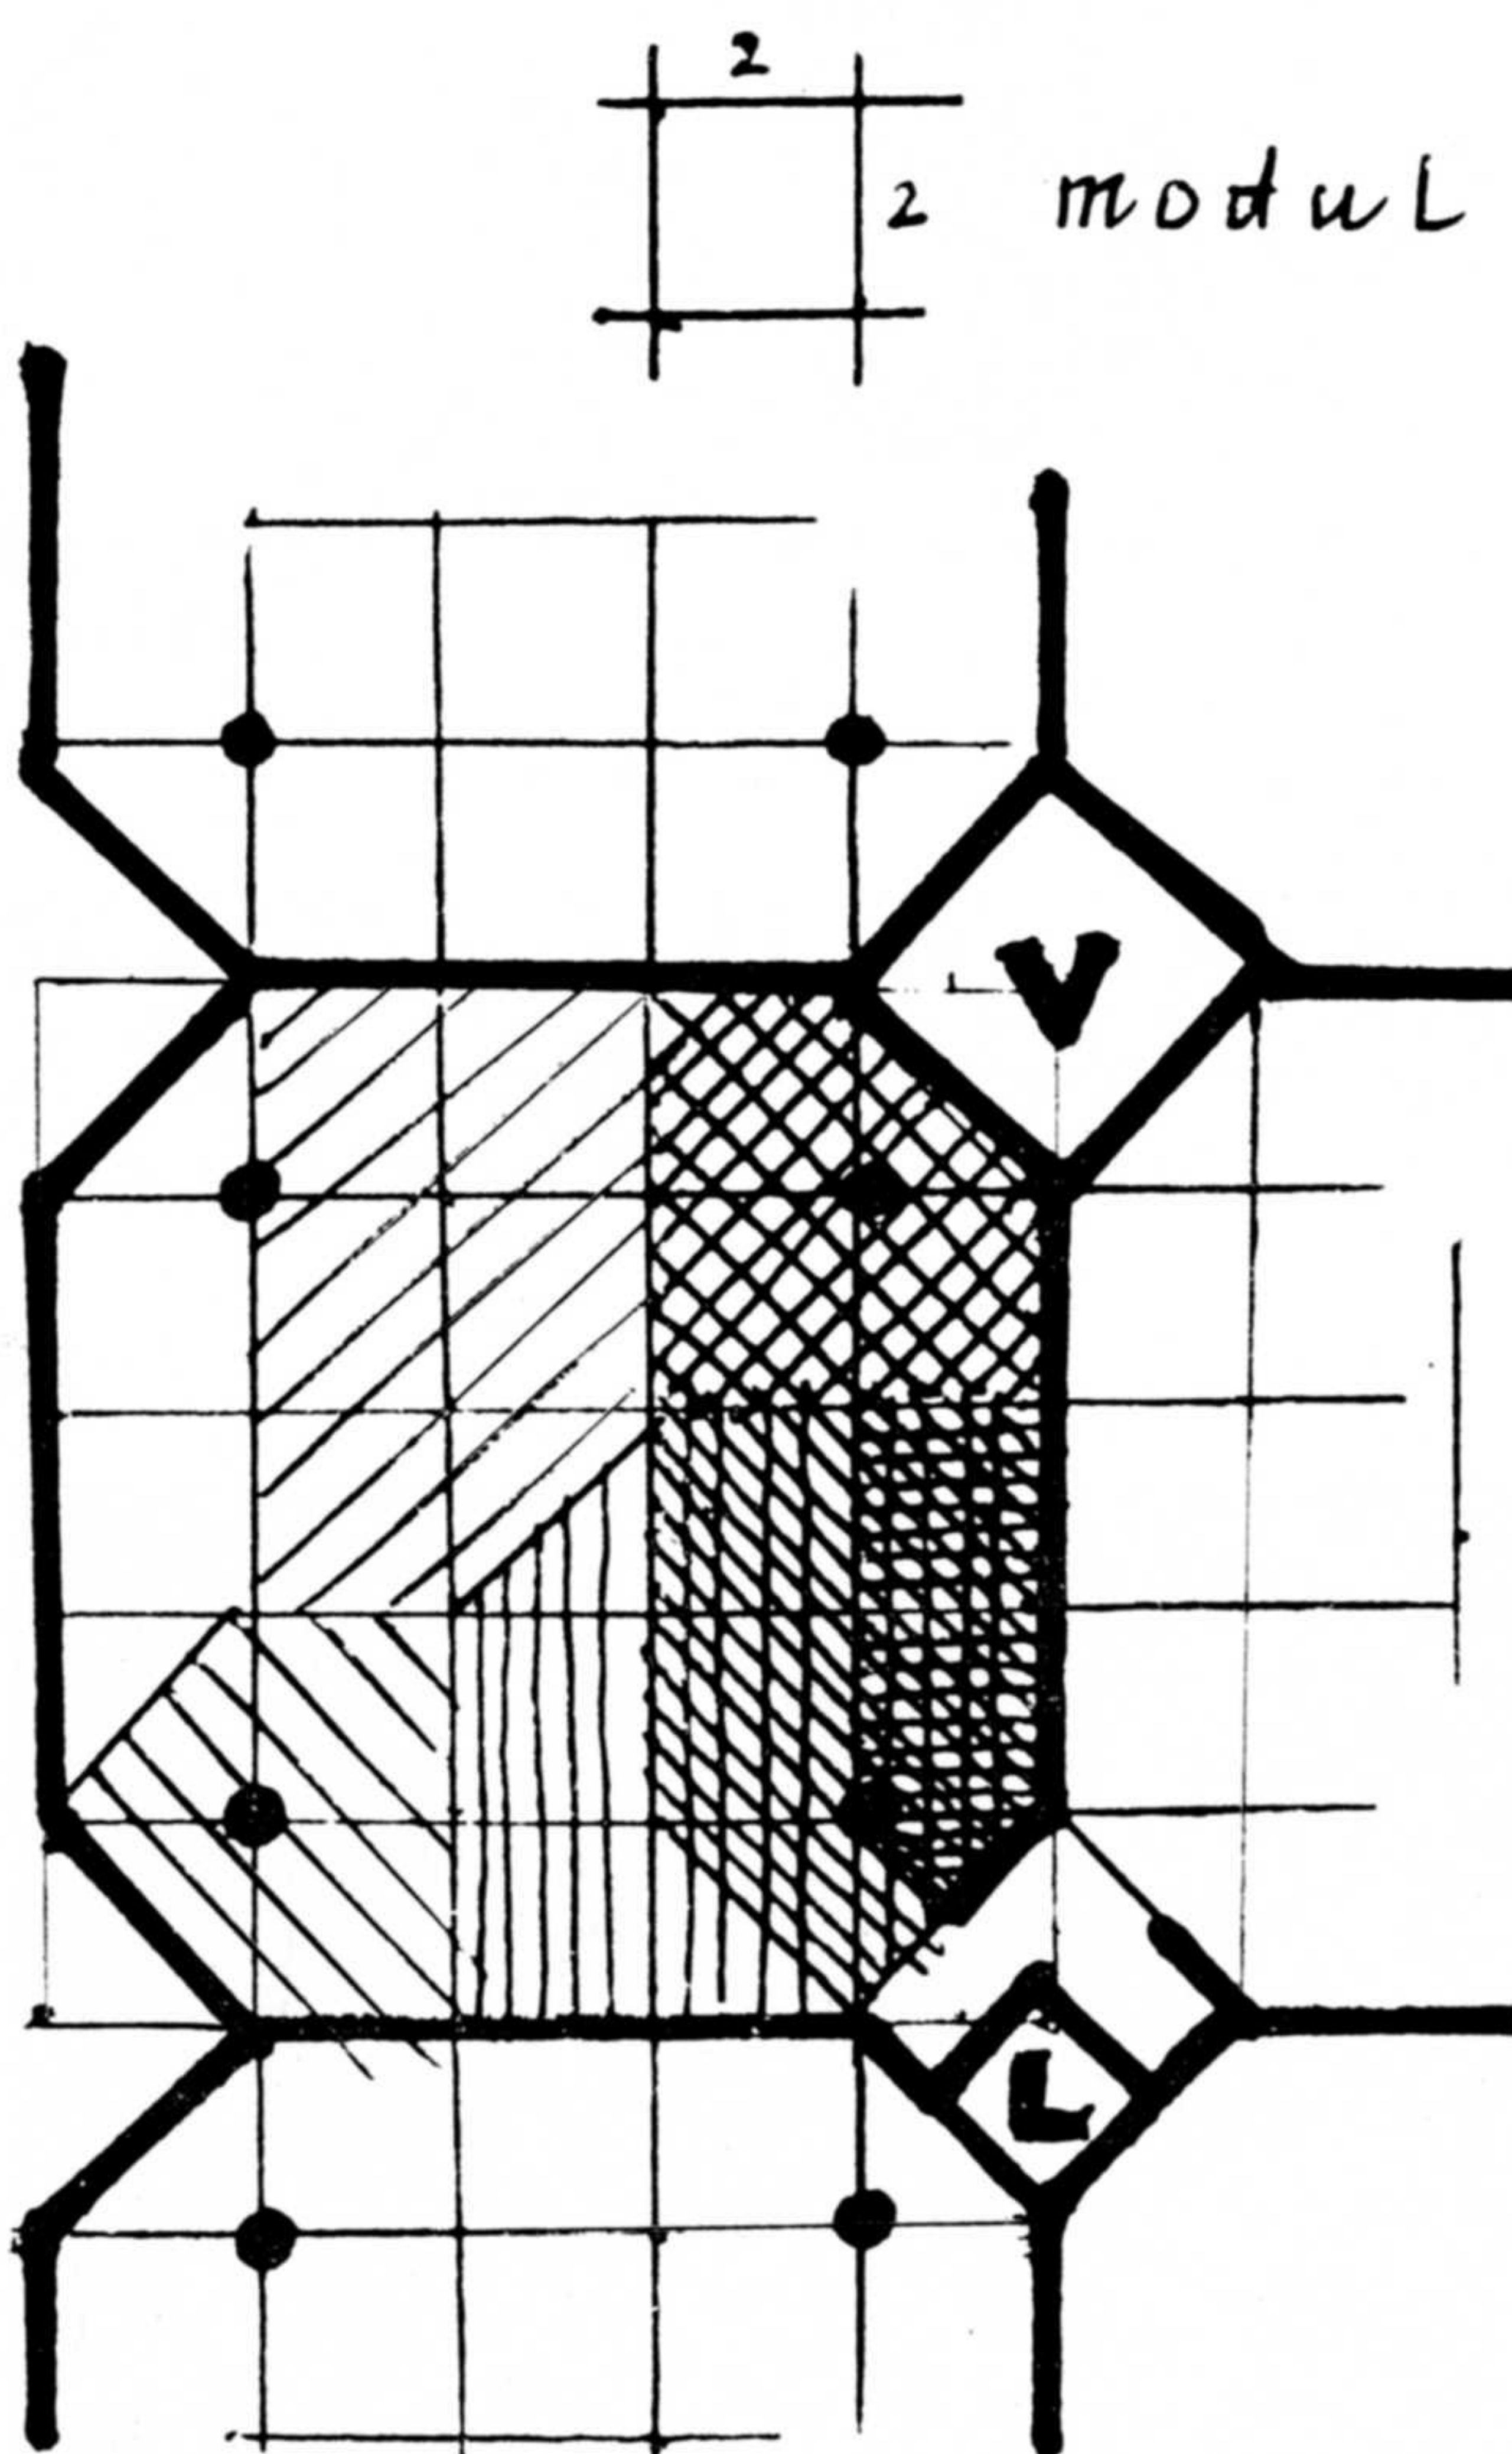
Vereinfachter „Globalgrundriß“ mit Modul, nach Projekt der Werkgruppe Linz (Teilabänderungen) V = Versorgungsschacht
